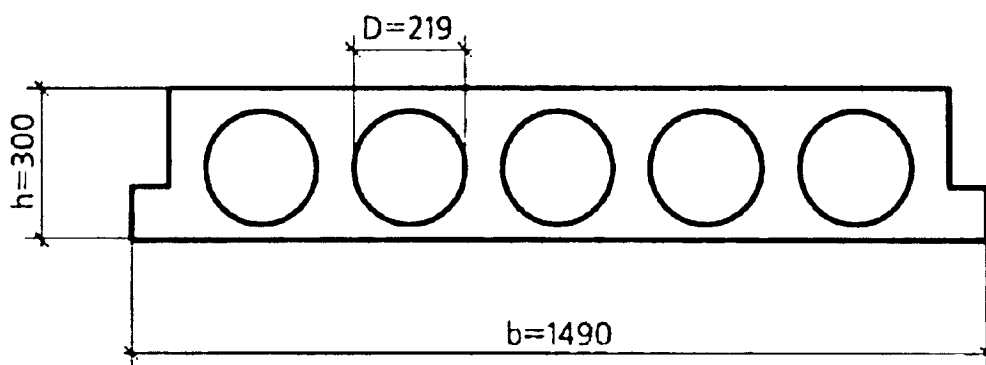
Схема многопустотной плиты перекрытия для общественных зданий
